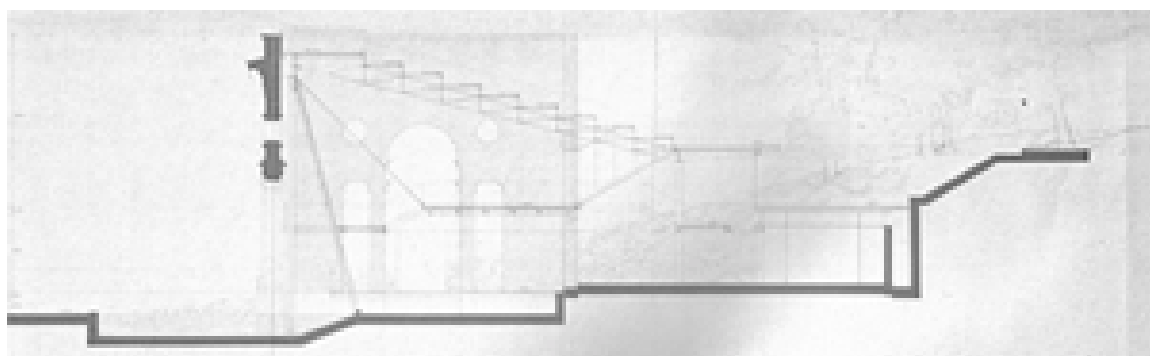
Sezione trasversale, progetto di massima, 1973/1974 (AABS)
